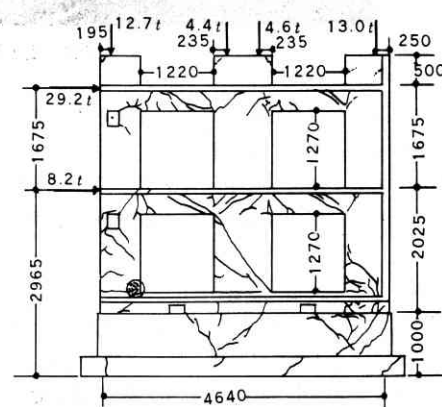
d B 構面のひび割れおよび破壊時の加力 (寸法 mm) 注: ○印の部分が曲げによって圧縮破壊を起こした
